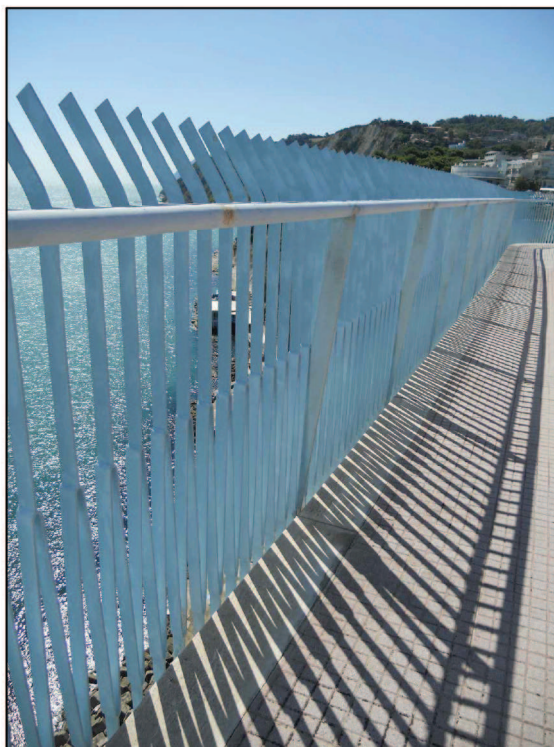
Dettagli parapetto terrazza q:+43,93m
